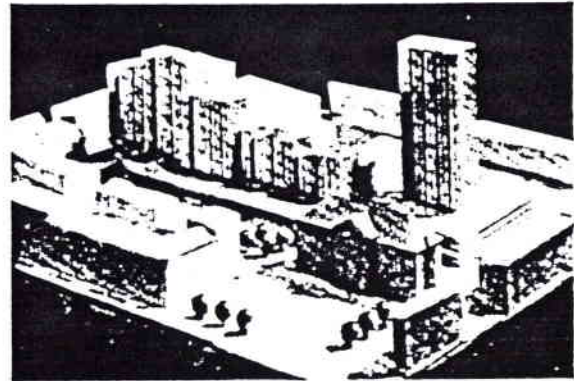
PROJETS DU GROUPE TETRA POUR LA RECONSTRUCTION
